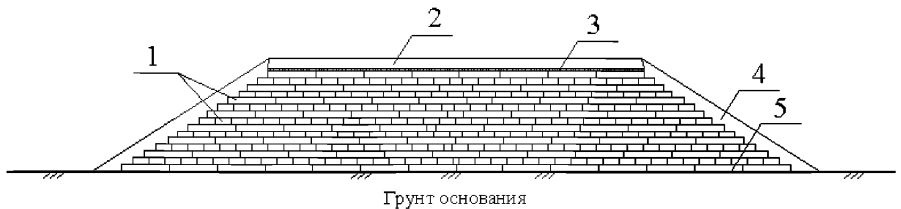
а - Конструктивная схема НППБ трапецеидальной формы: 1 – ППБ, 2 – дорожная одежда, 3 – РП, 4 – грунтовое покрытие откосов, 5 – выравнивающий слой песка
